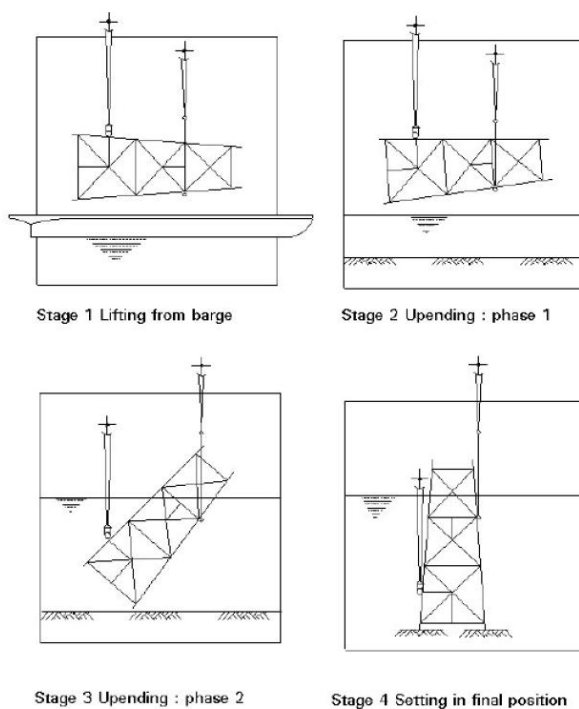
Croquis de pose de la sous-structure (Source : DNV)
